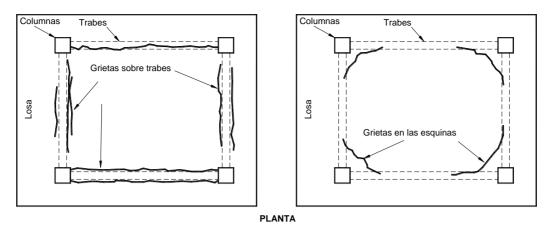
Grietas en losas sobre trabes perimetrales y en esquinas
